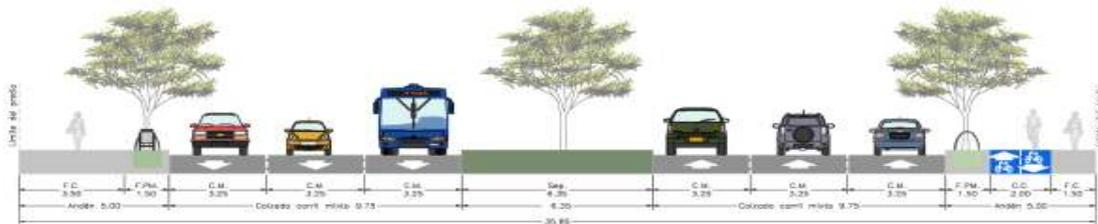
Sección Típica sobre la Av. 1 de Mayo entre La Av. Ciudad Villavicencio y la Autopista Sur.
